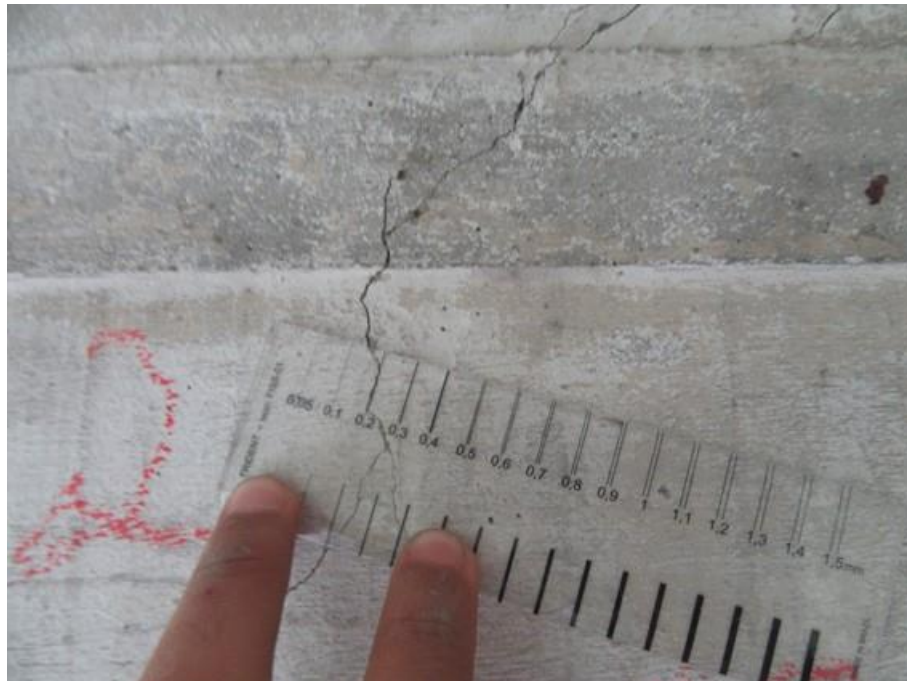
(IMG\_1056): Viga Longarina Oeste – Face Leste.
